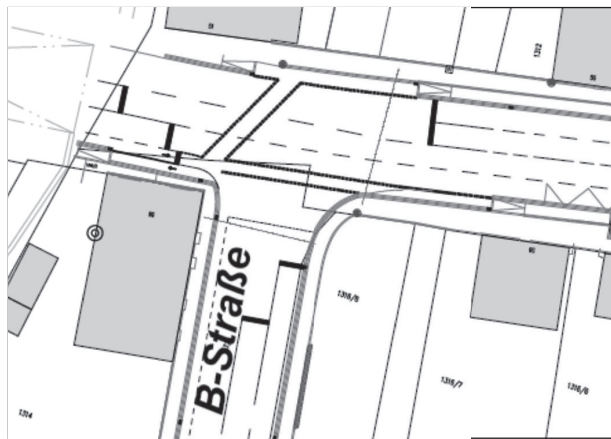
Lageplan Knotenpunkt B-Straße Beispiel 1
